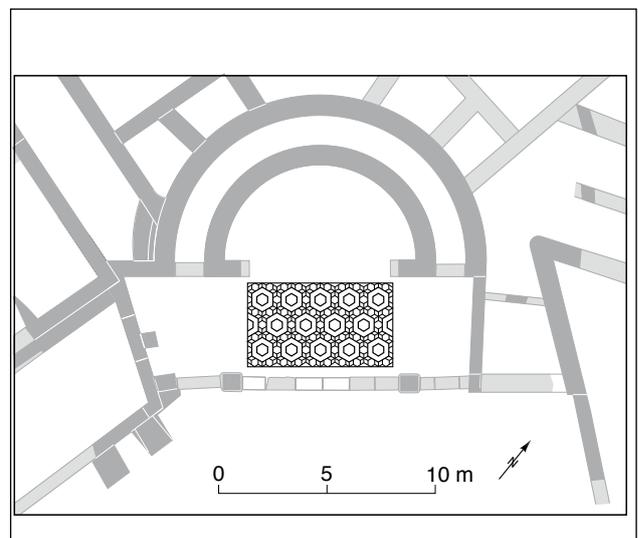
Plan du pavillon avec emplacement approximatif du pavement
